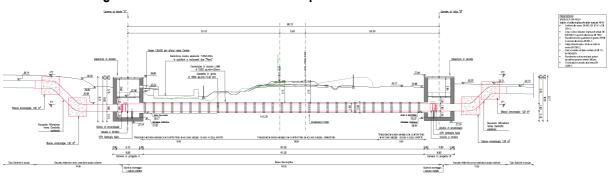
Attraversamento DN1600 pk 21+000 – Sezione Longitudinale Canna Lato Catenanuova
